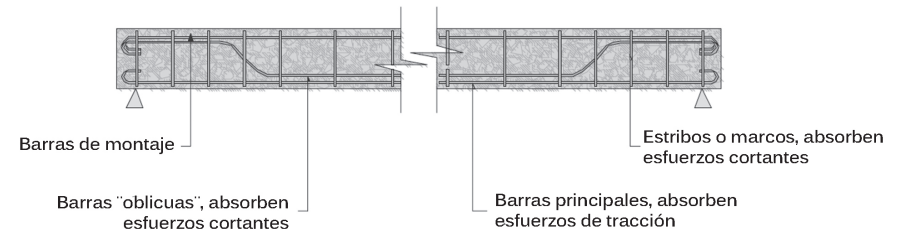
Comportamiento de una estructura de Hormigón Armado.
